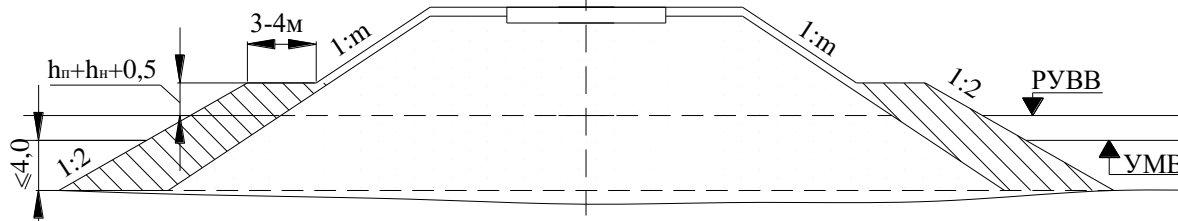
Поперечное сечение подходов с бермами
